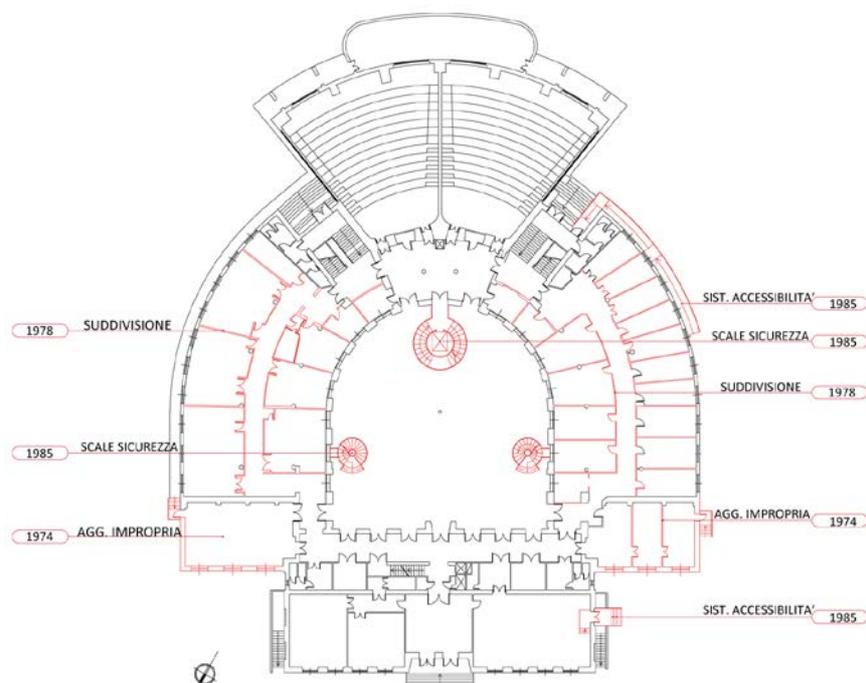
Planimetria Piano Terra – Stato originario e successive modifiche⁵
